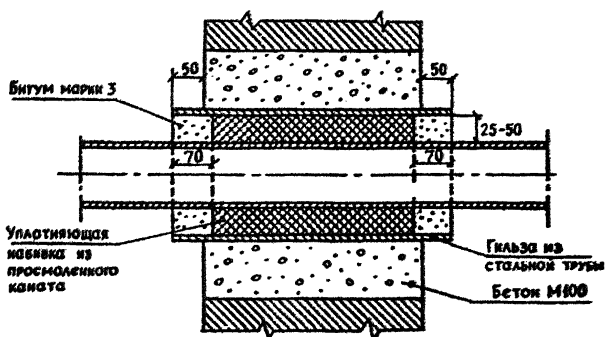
Заделка отверстий для пропуска трубопроводов в стенах подвалов.
